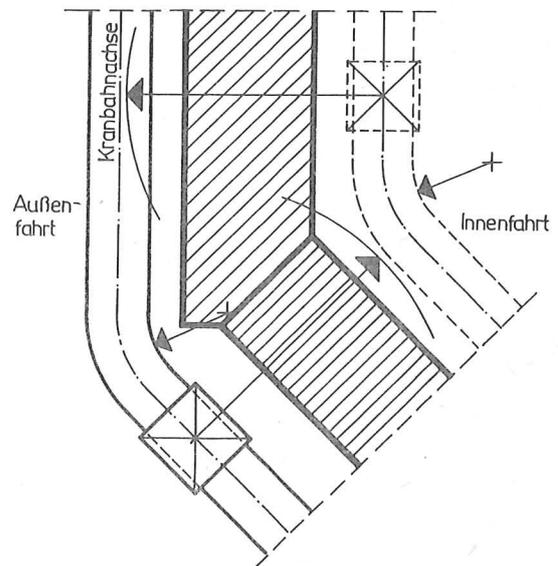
Kranbahnanlage mit ausgebauten Kurvenbereich
